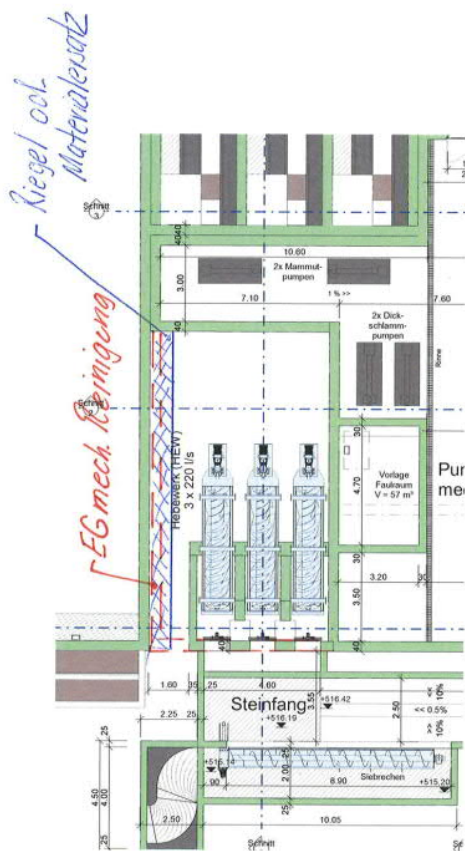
Planausschnitt; Grundriss mechanische Reinigung
